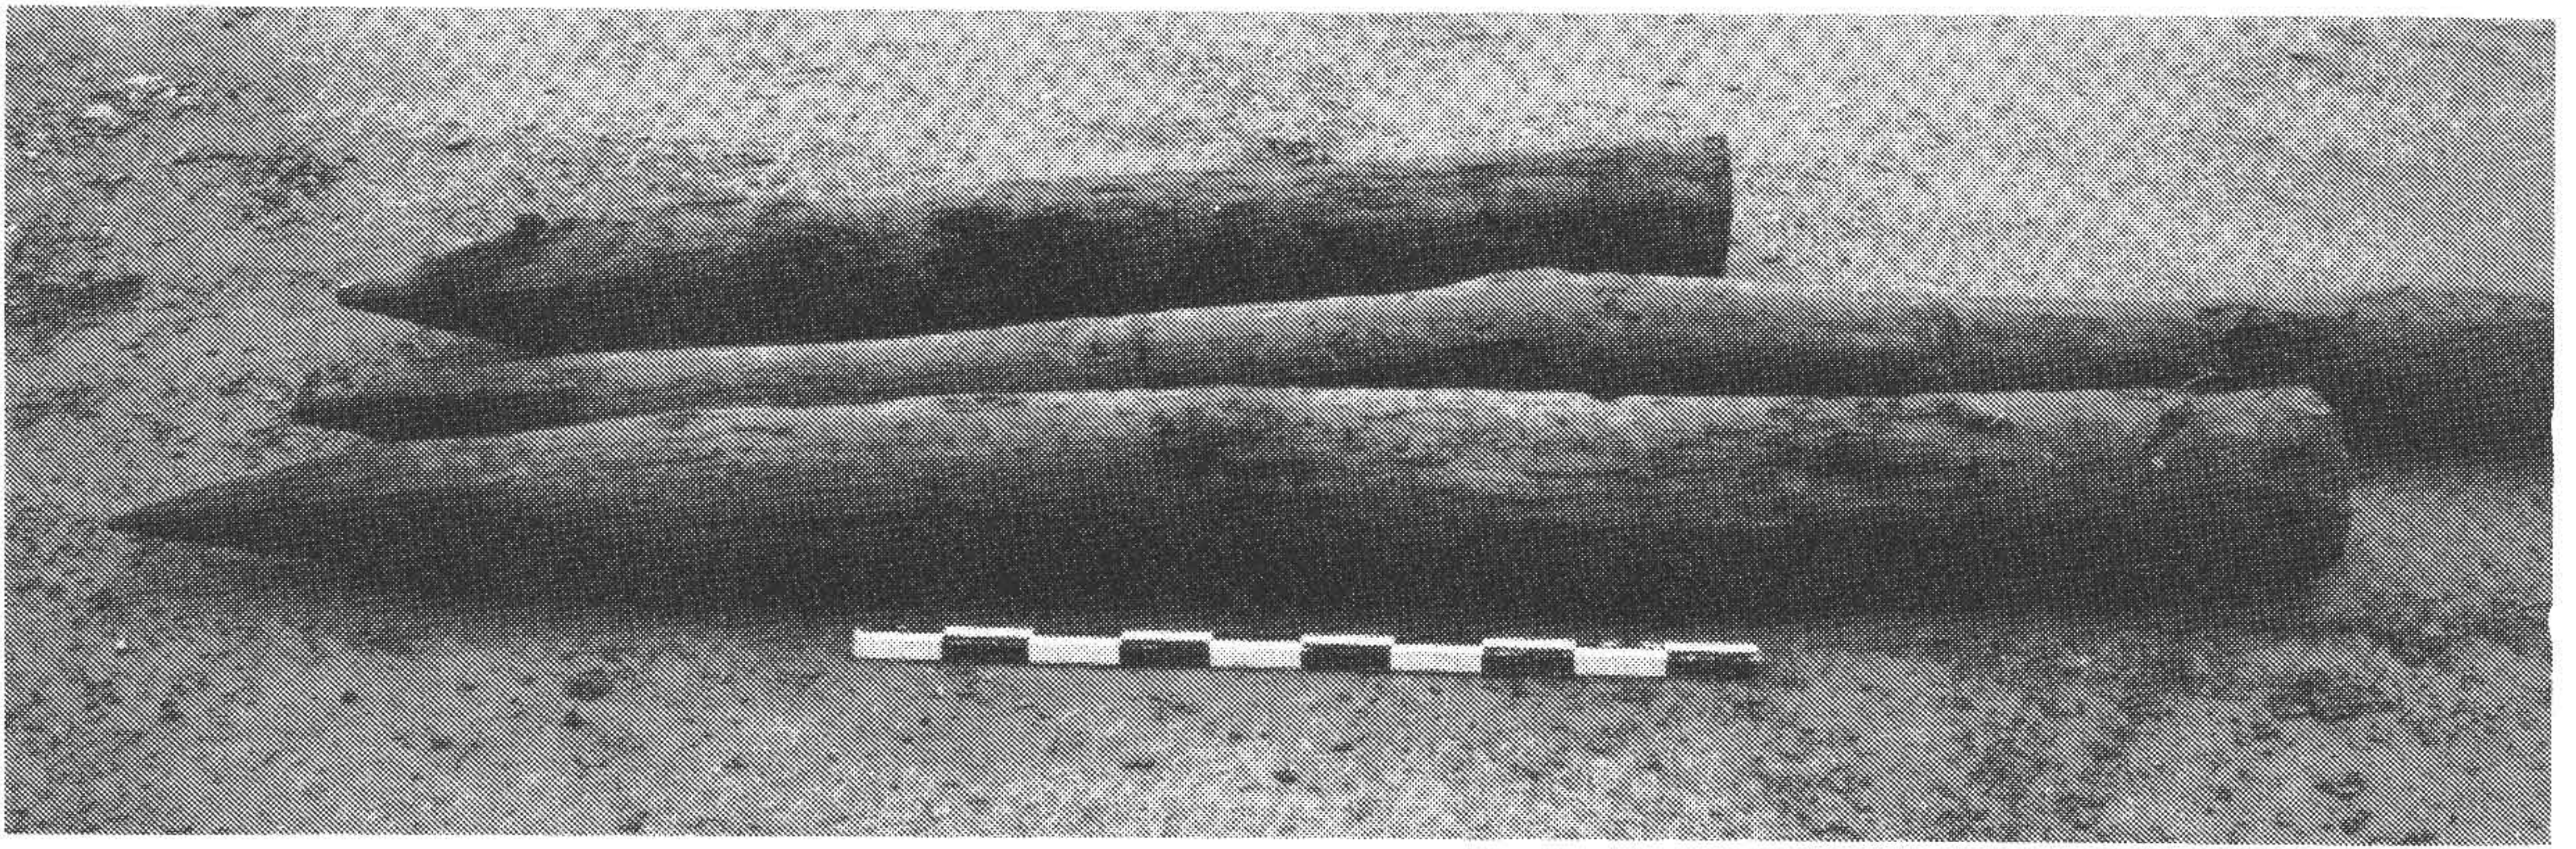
Caserne Barbade, fouilles 1986. Trois pieux de fondation du pignon sud.
